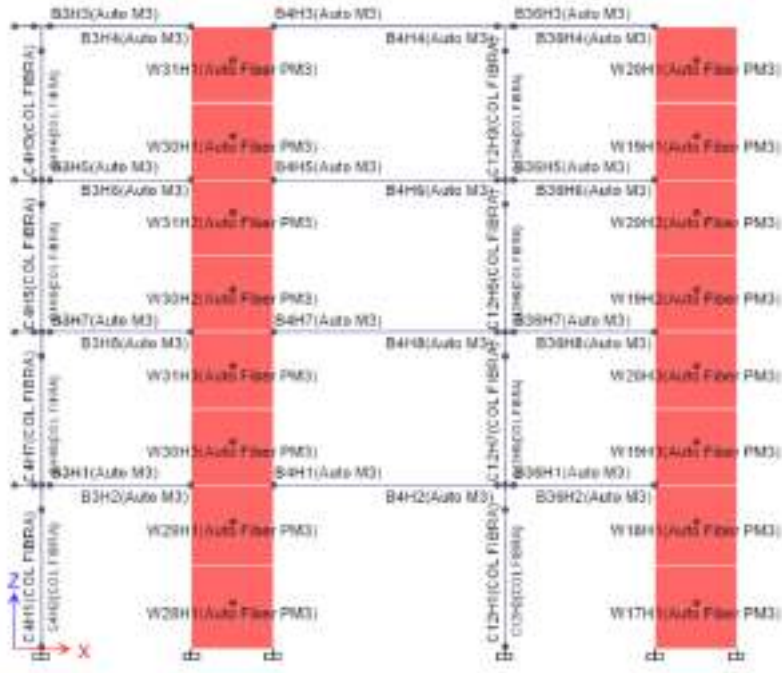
Asignación de la rotulas plásticas para elemento frame y Shell
